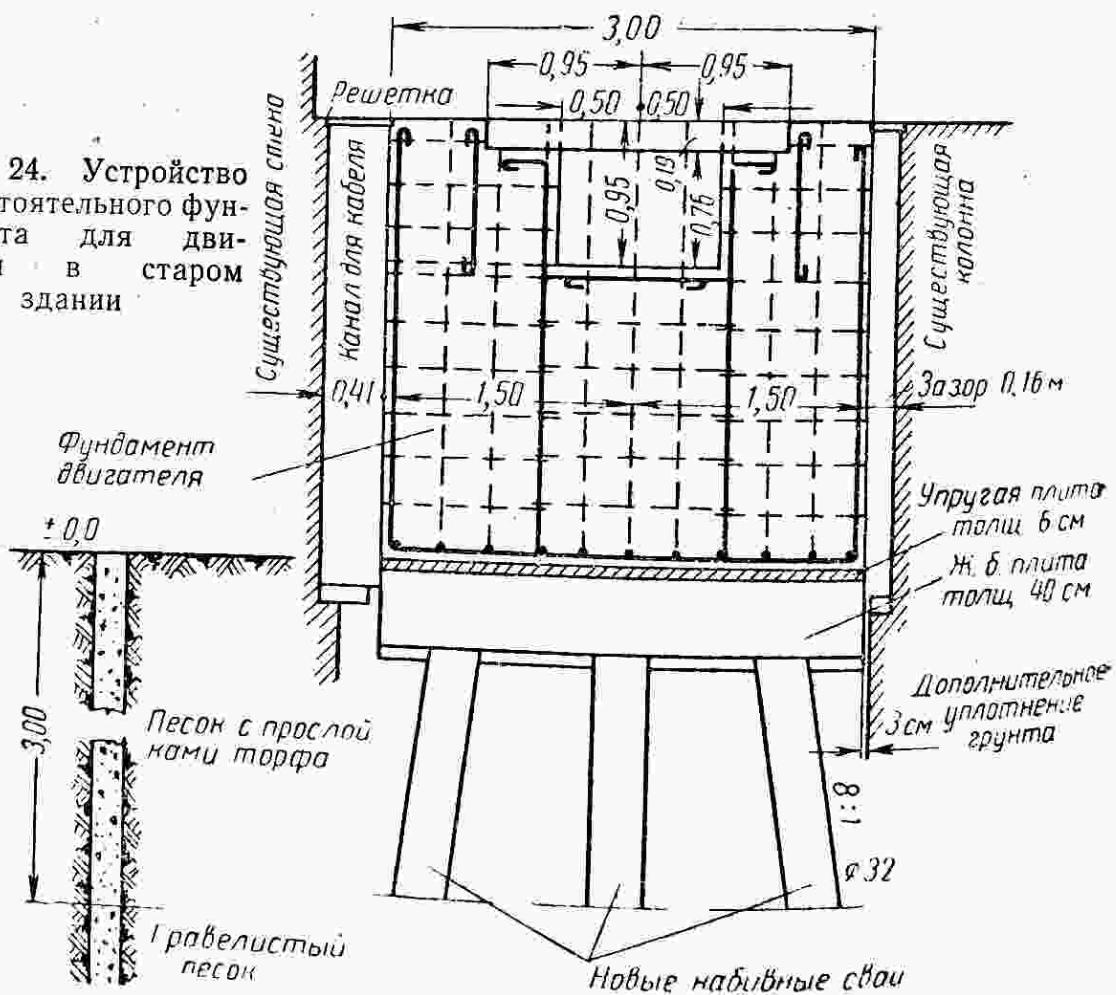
Устройство самостоятельного фундамента для двигателя в старом здании
